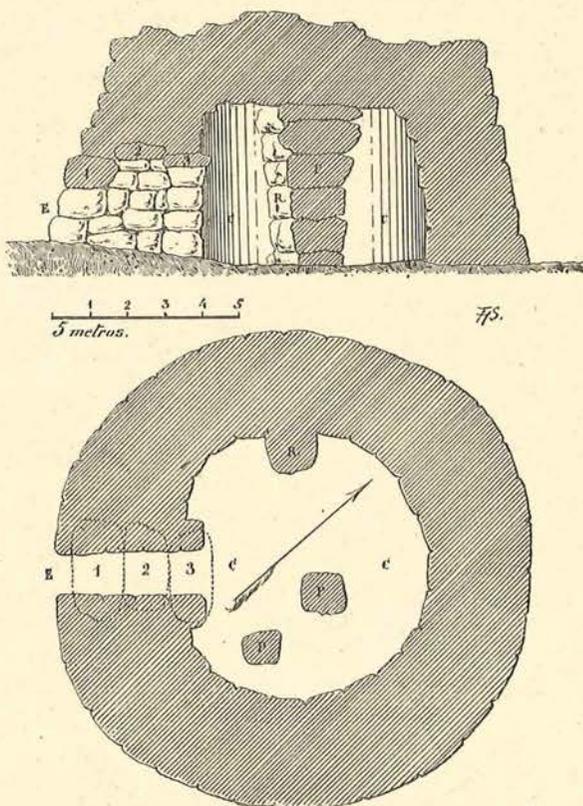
TALAYOT DE SAN AGUSTIN. — Coupe et plan.
